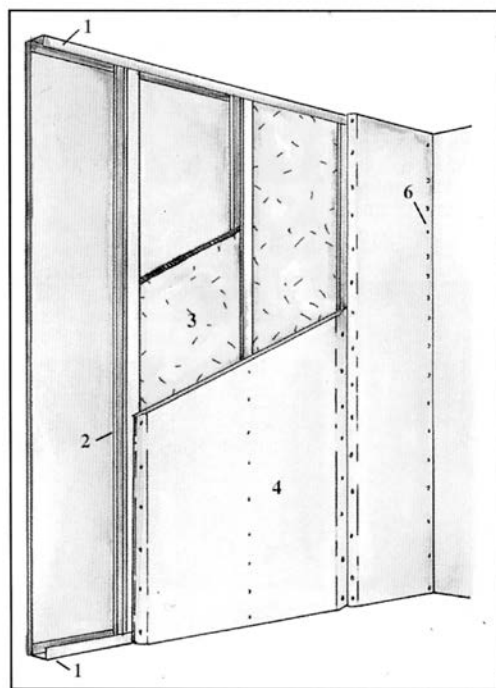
Primjer izvedbe lagane dvostruke pregrade s drvenom potkonstrukcijom
